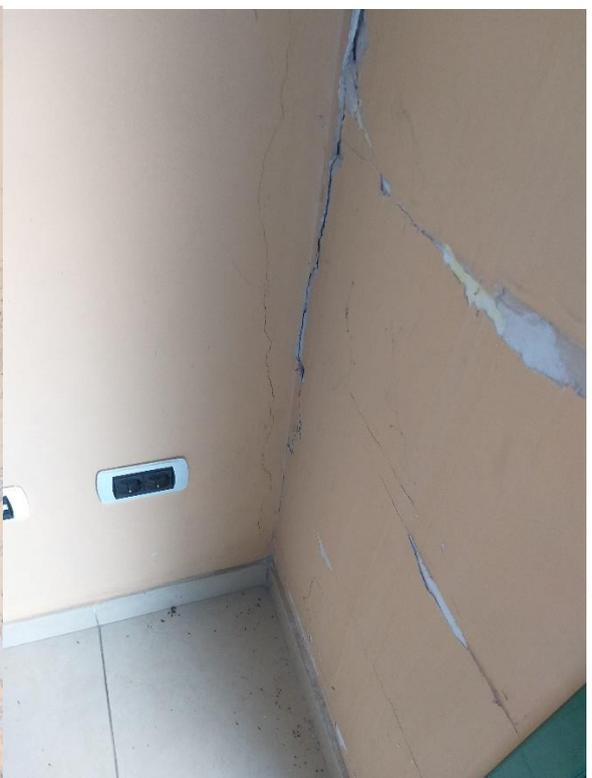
Rotura de falso techo por humedad por filtración o accidente. Fisuras horizontales, verticales y diagonales. Abombamiento de muro.
